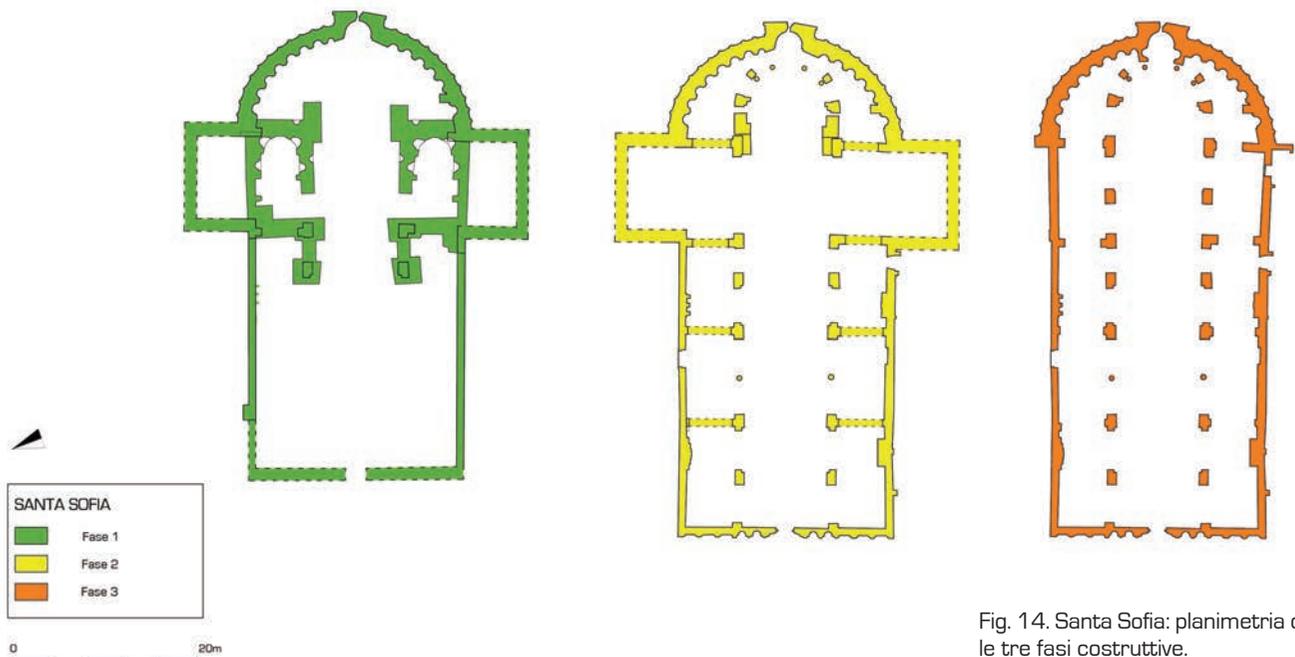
Santa Sofia: planimetria con le tre fasi costruttive.
